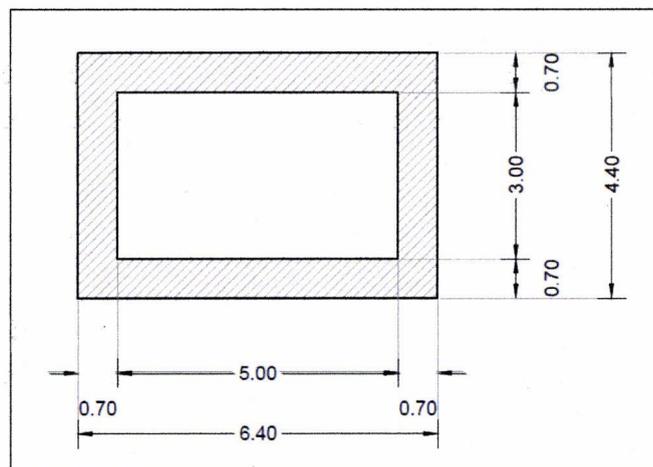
Sezione tipo dell'attraversamento idraulico scatolare di Via degli Scaligeri.
